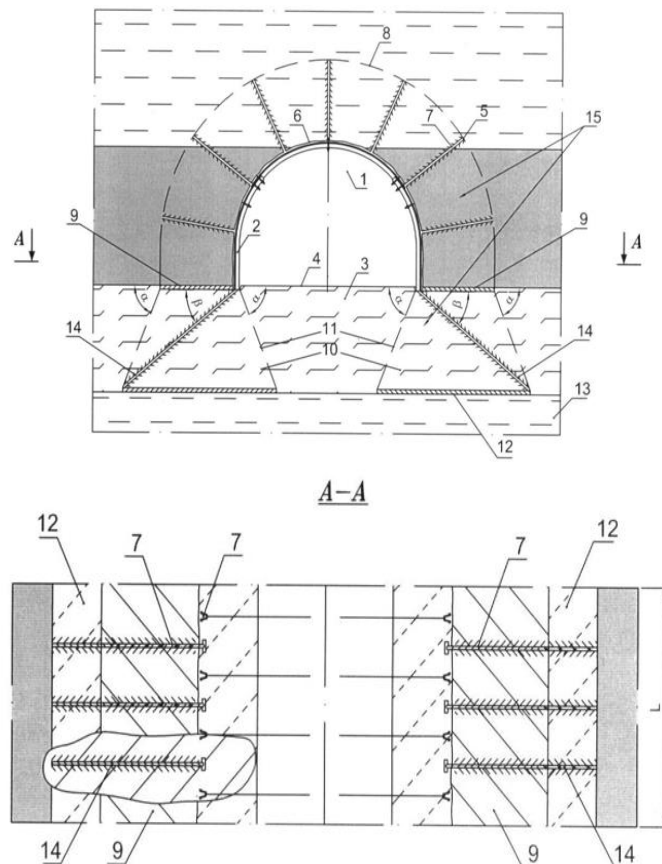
Установка анкерных болтов по своду выработки [3].
